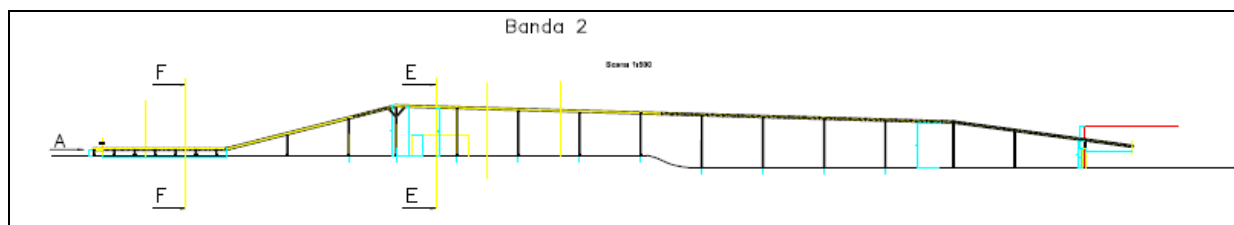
Varianta II - Banda transportoare ce traversează o platformă betonată
